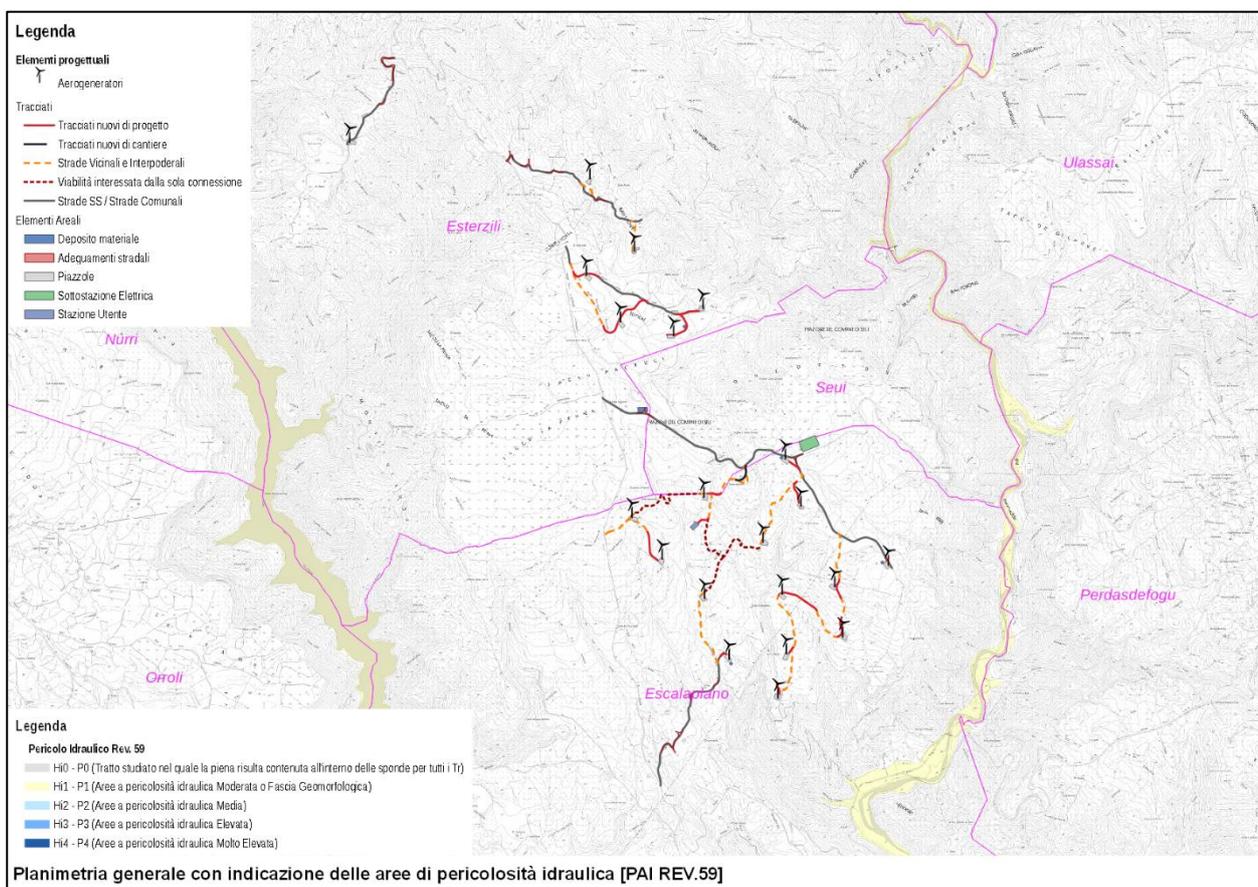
Planimetria generale con indicazione delle aree di pericolosità idraulica [PAI REV.59]
